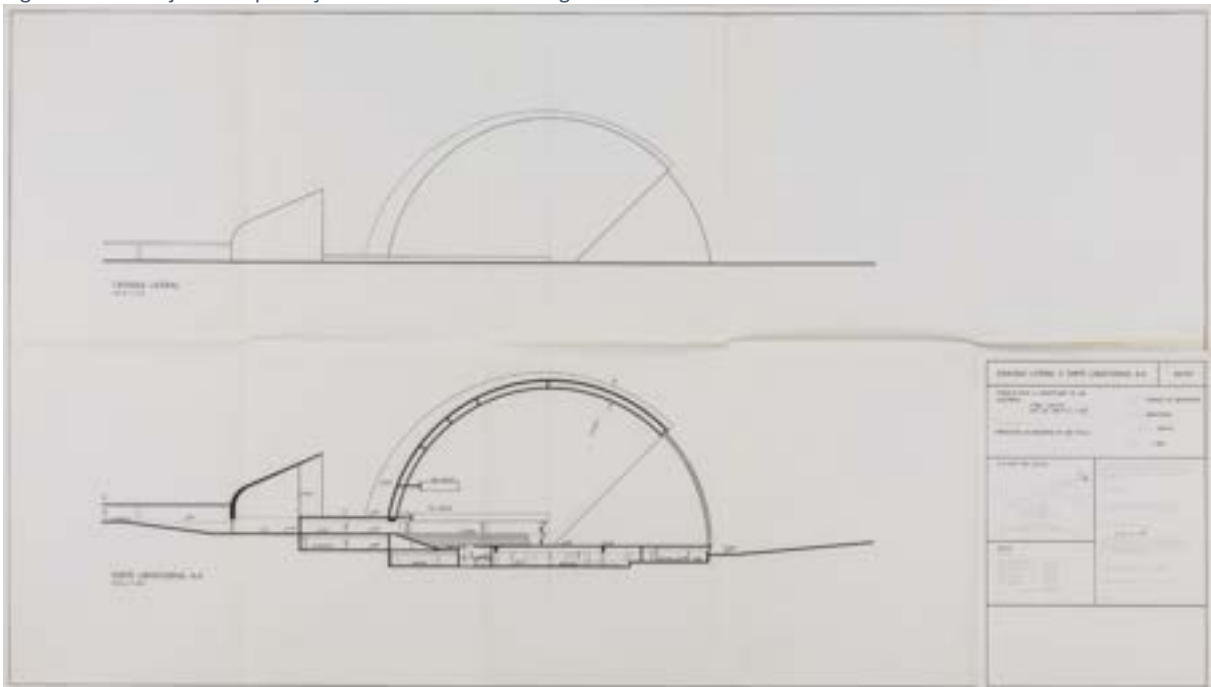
Projeto de aprovação – Fachadas transversais – foto Rafael Schimidt – fonte: Acervo do DEPAVE
